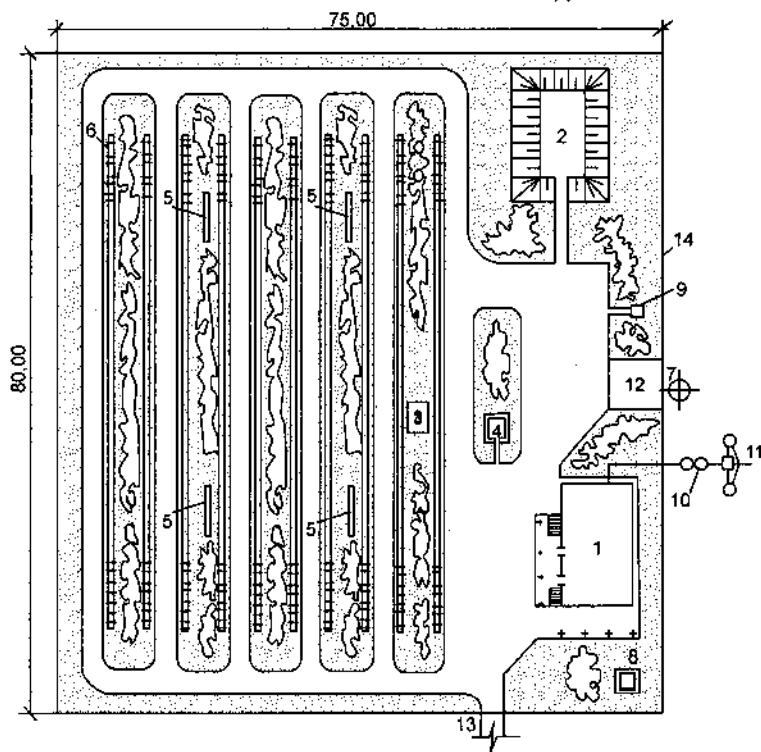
Схема генерального плана пчеловодческой фермы на 300 пчелиных семей (ТП 808-05-18.86):
